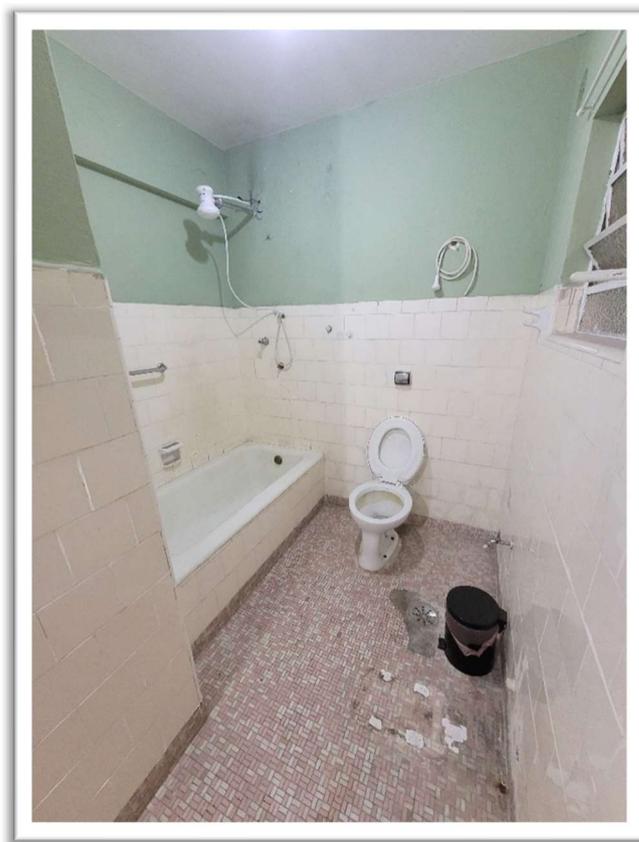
BANHEIRO – IMÓVEL PARADIGMA
